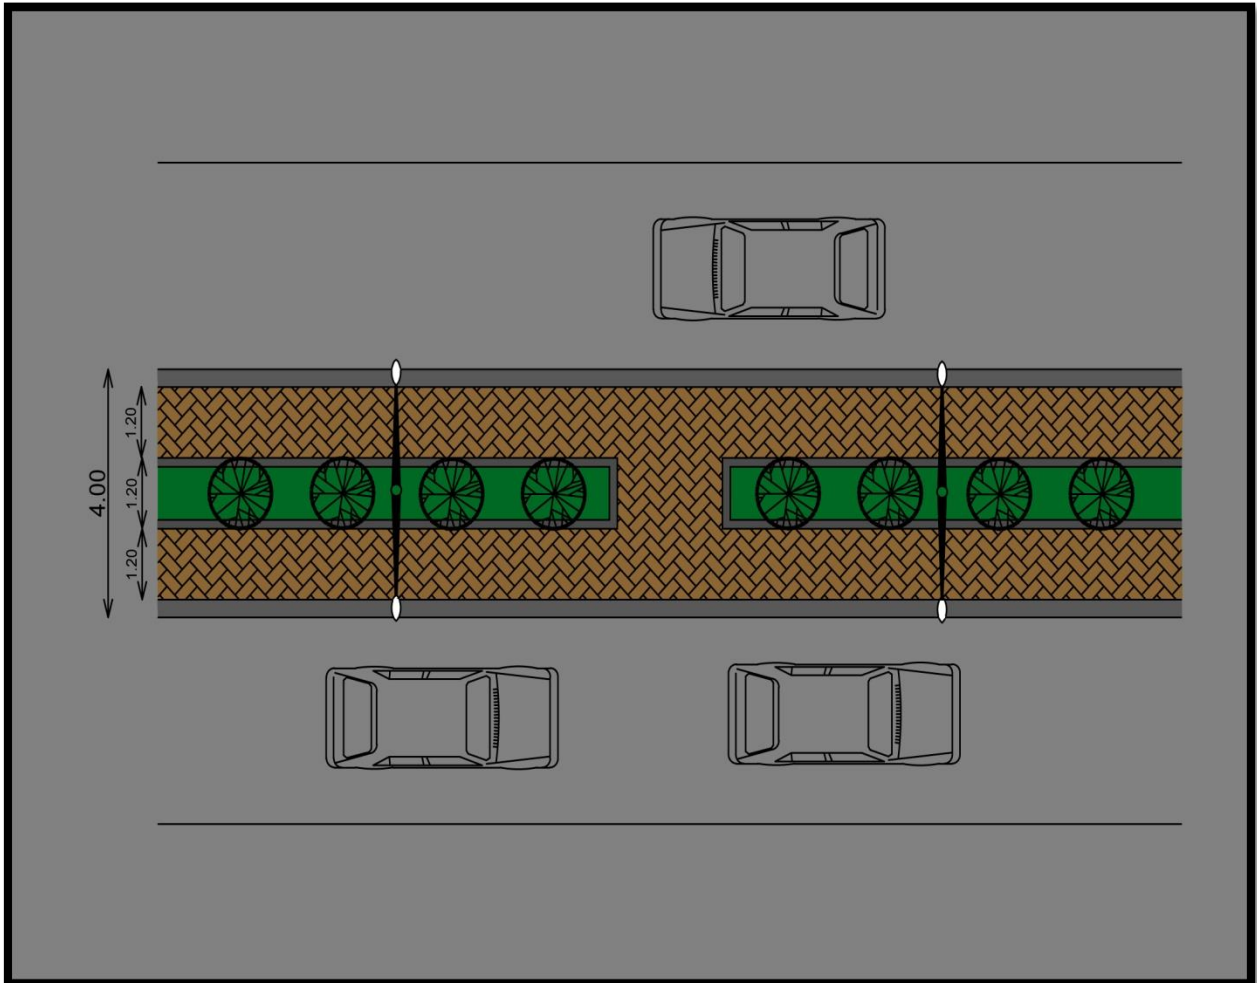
Análisis de áreas de camellón. Fuente: A. Villegas
